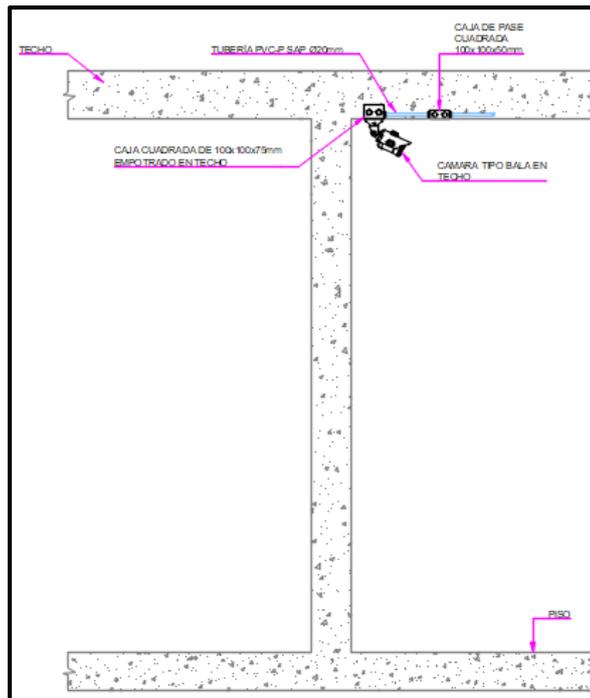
Ubicación de Cámara tipo Bullet instalada en techo.
